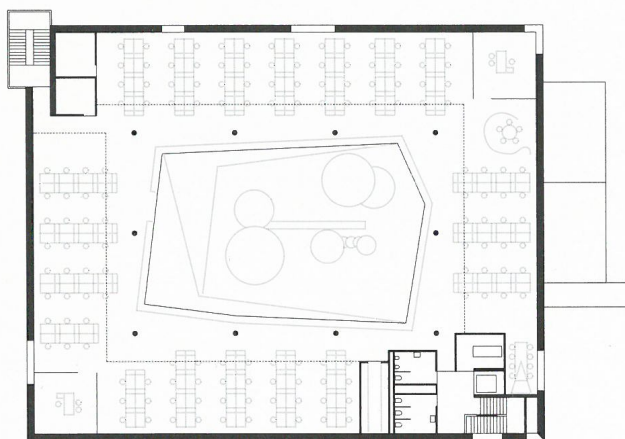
Grundriss EG ©Paul Katzberger
